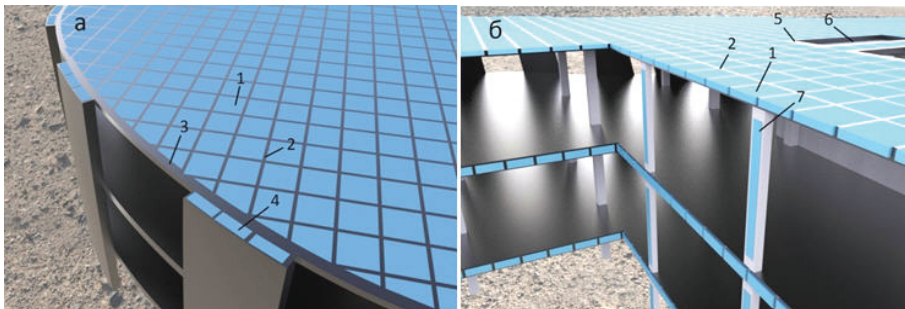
Конструкція елементів каркаса системи «Монофант»: а — конструкція перекриття; б — конструкція перекриття з отворами; 1 — вкладка-пустотоутворювач; 2 — внутрішні ребра жорсткості перекриття; 3 — зовнішнє окантування перекриття ребром жорсткості; 4 — вкладка-пустотоутворювач у зовнішніх елементах жорсткості; 5 — внутрішнє окантування ребром жорсткості; 6 — отвори в перекритті; 7 — вкладка-пустотоутворювач у колоні
